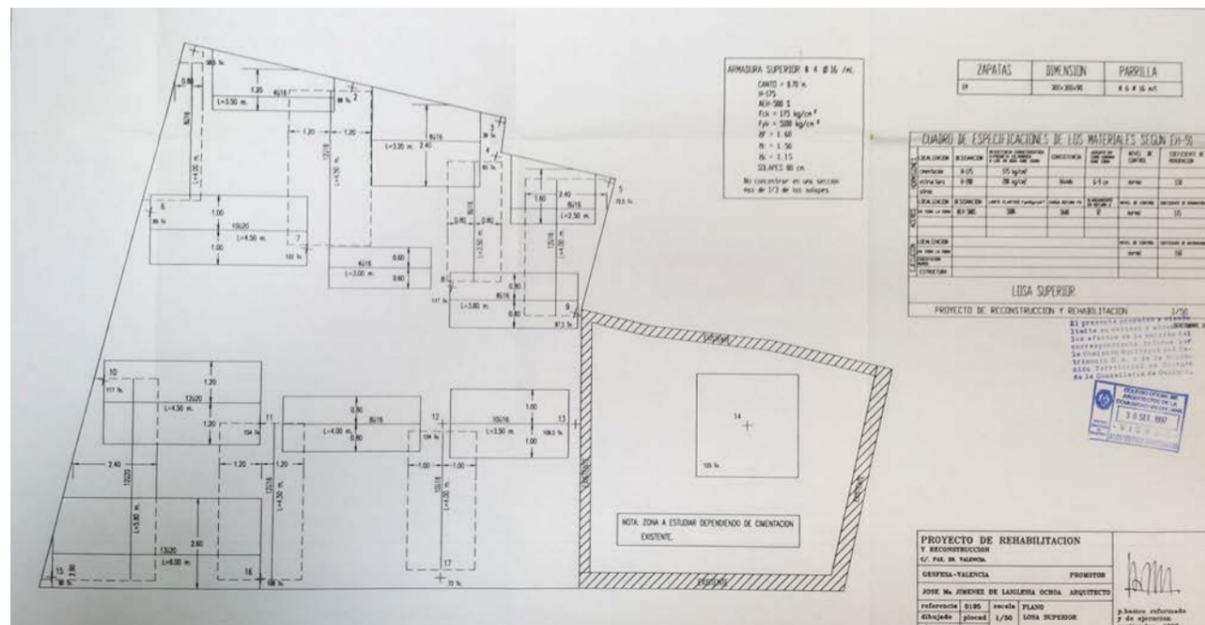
Losa de cimentación. Armadura superior 4 Ø 16 / ml
